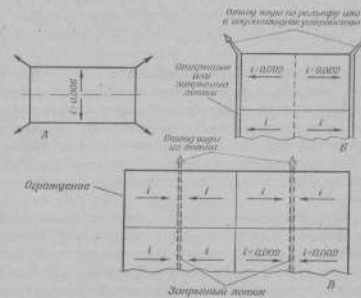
Схемы вертикальной планировки и водоотвода: А — отдельно стоящая площадка, В — площадки, расположенные в два (и более) ряда
